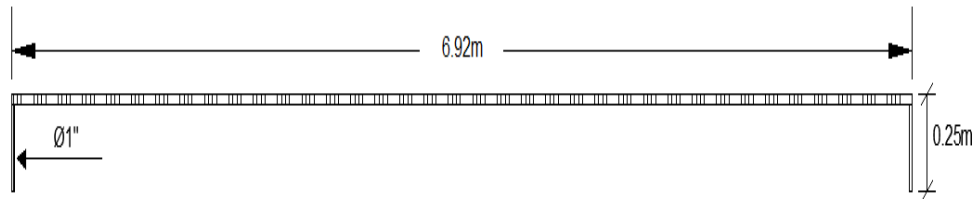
Detalle del acero longitudinal superior. Fuente: Elaboracion Propia
